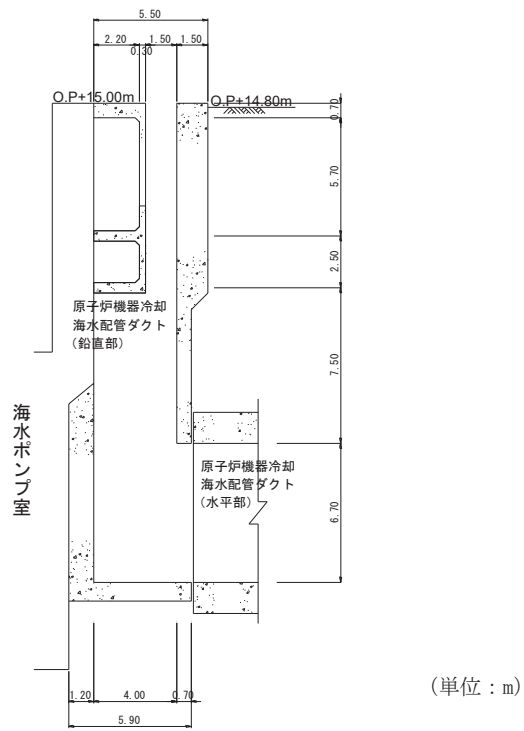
原子炉機器冷却海水配管ダクト (鉛直部) 縦断面図 (A-A 断面)
